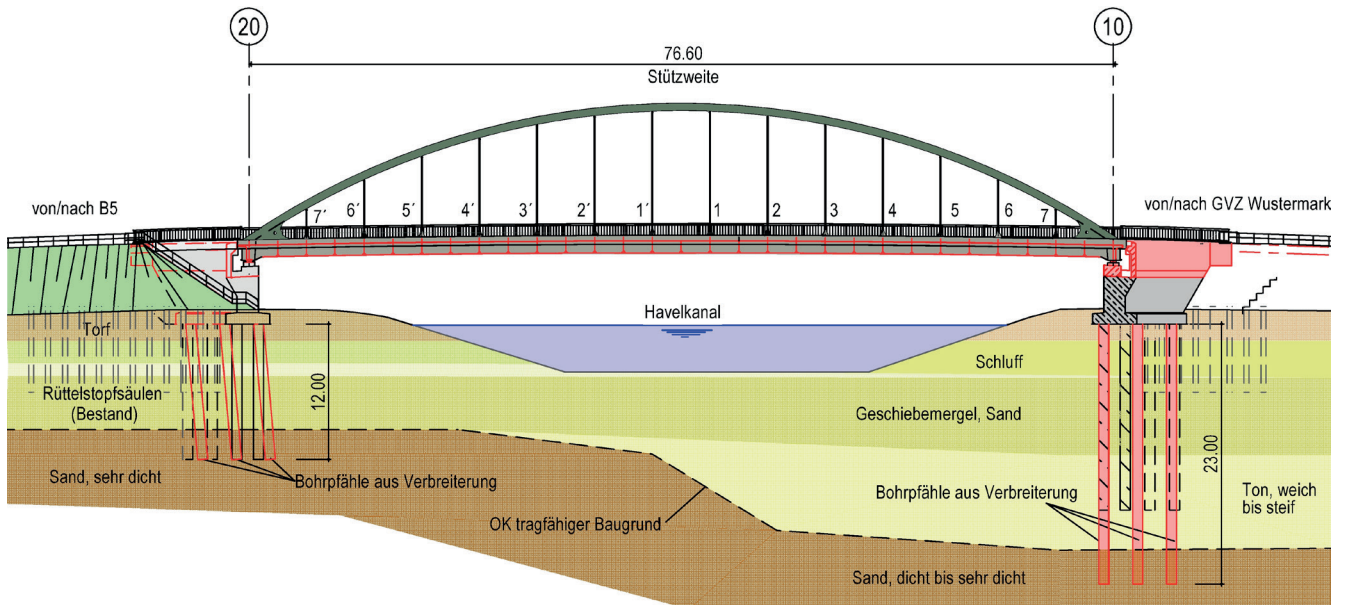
Längsschnitt Bauwerk mit Baugrundmodell und Hängernummern
